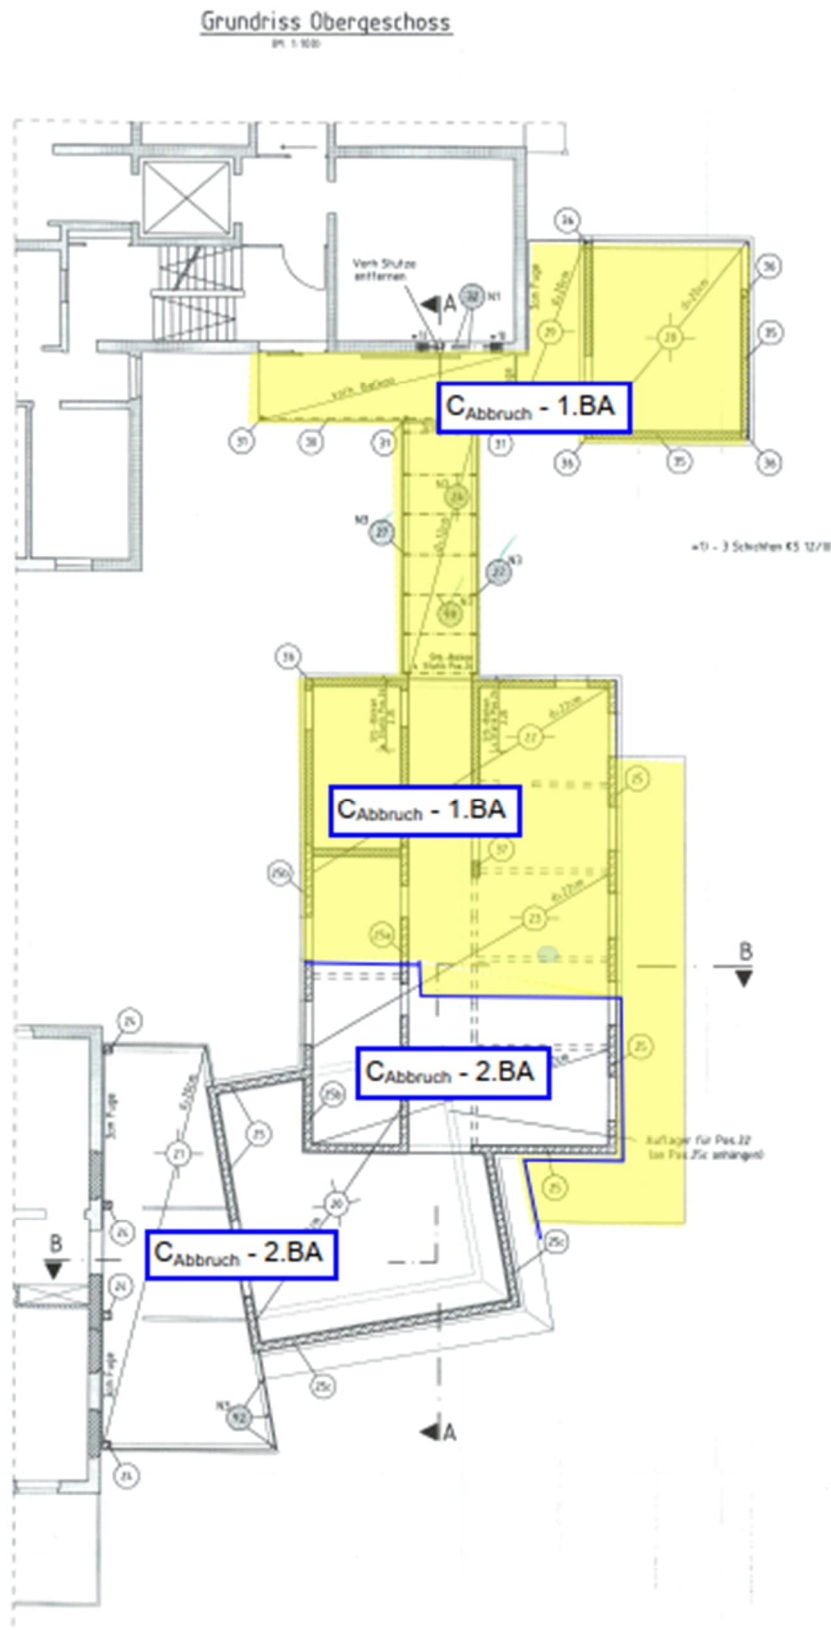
Auszug Positionsplan Grundriss EG P3b vom 29.09.2003
